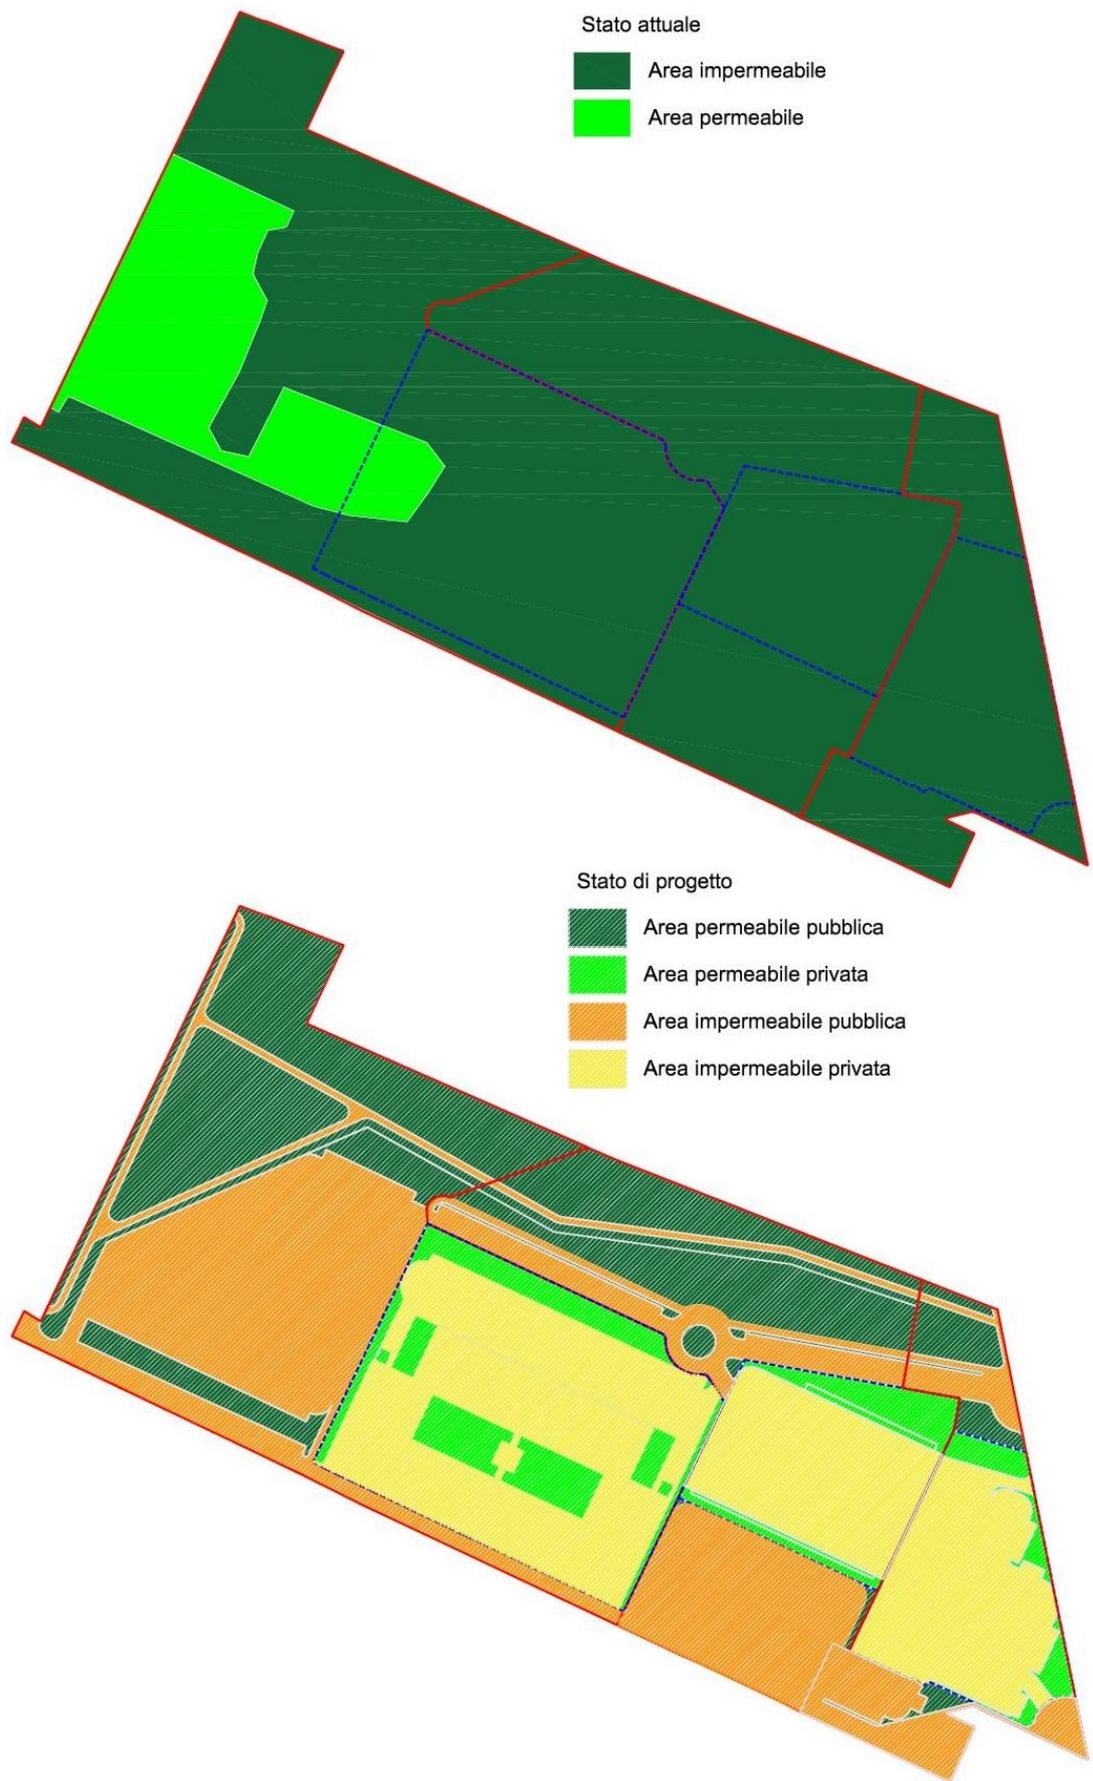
Planimetria delle aree permeabili e impermeabile (a sinistra stato attuale, a destra stato di progetto)
